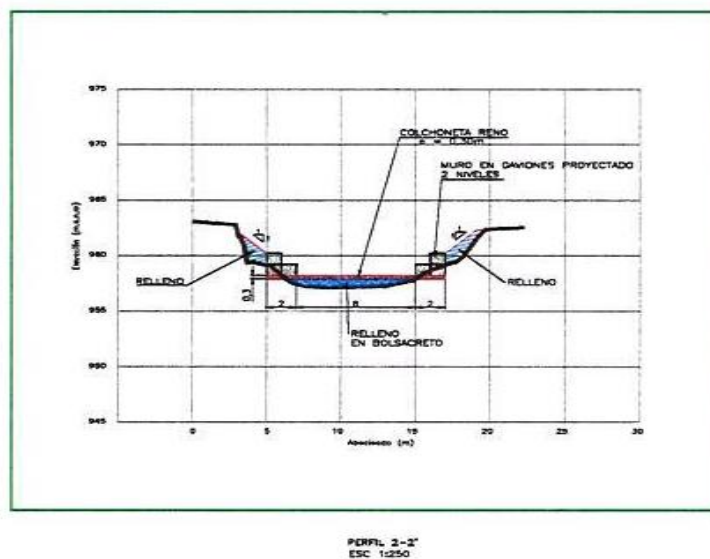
Corte transversal de las obras de protección marginal sobre la quebrada Murillo.
